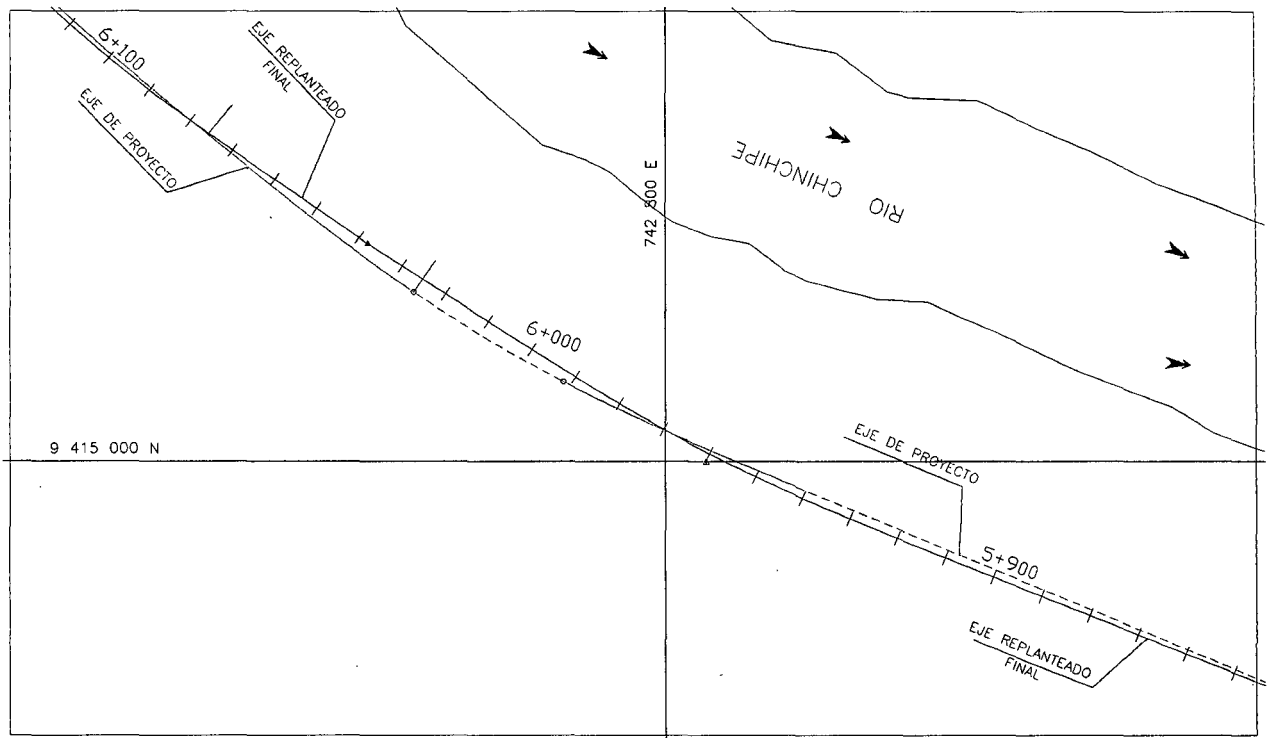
Plano en planta de la comparación del eje del proyecto y el replanteado de la variante 01.
